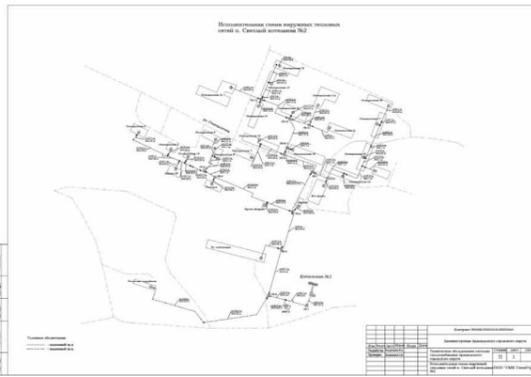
Исполнительная схема наружных тепловых сетей котельной №2
